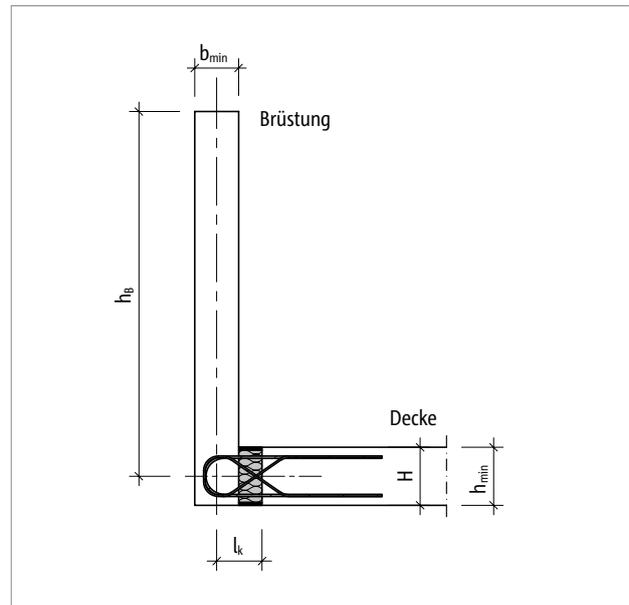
Schöck Isokorb® T Typ AP: Statisches System Brüstungshöhe h_B ; Isokorb® Höhe H
